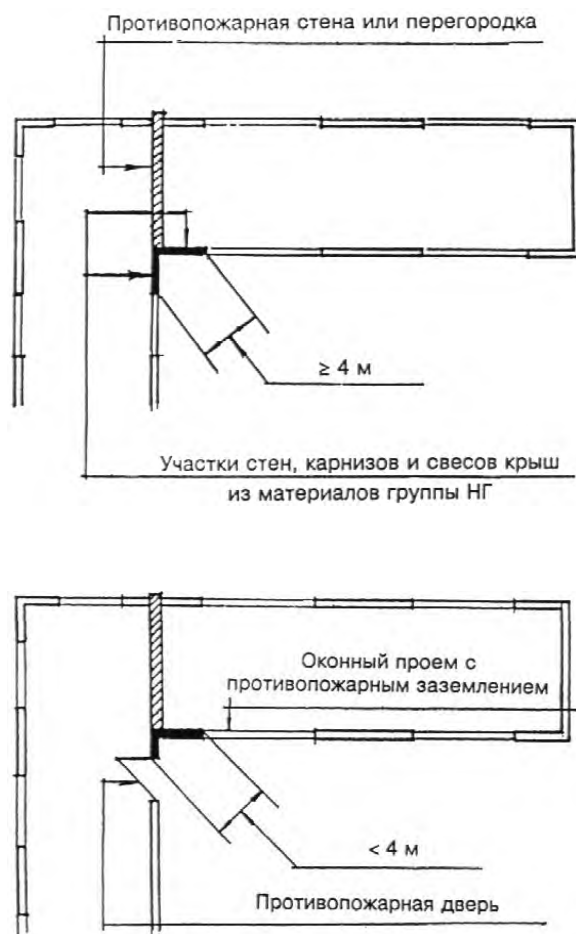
Участок стены в местах примыкания частей зданий под углом, разделенных противопожарными стенами
